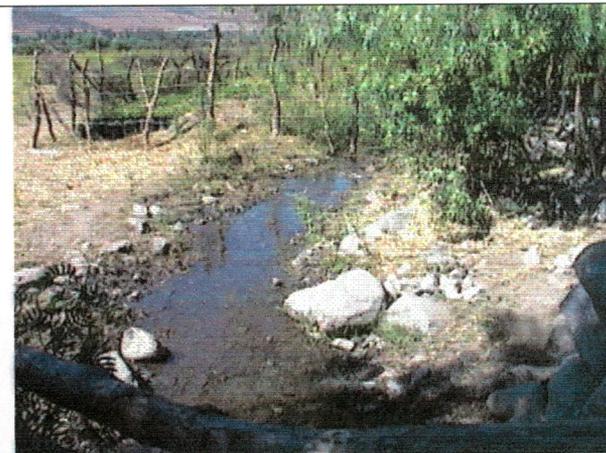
Sección sin Revestimiento Canal Las Vegas (Cruce de Camino)
